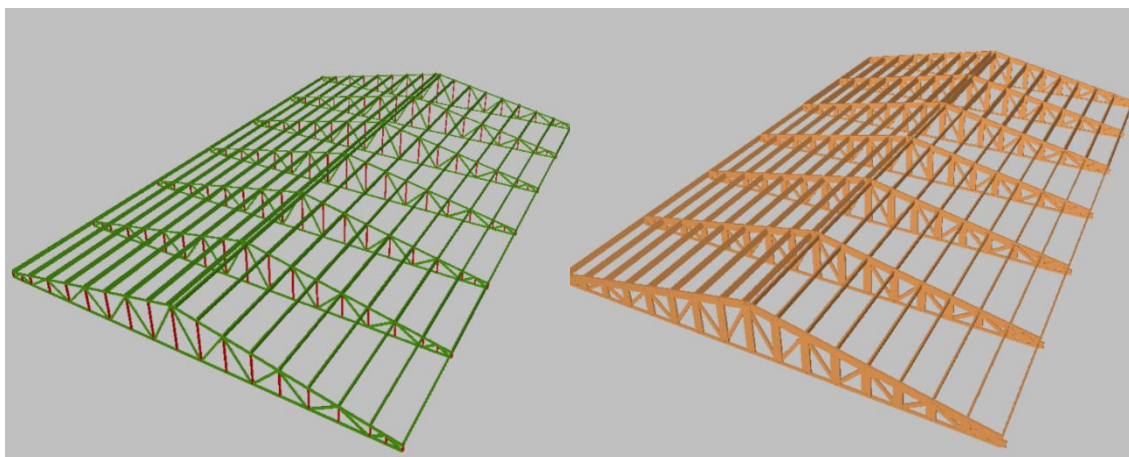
Vista tridimensional da estrutura metálica e de madeira
